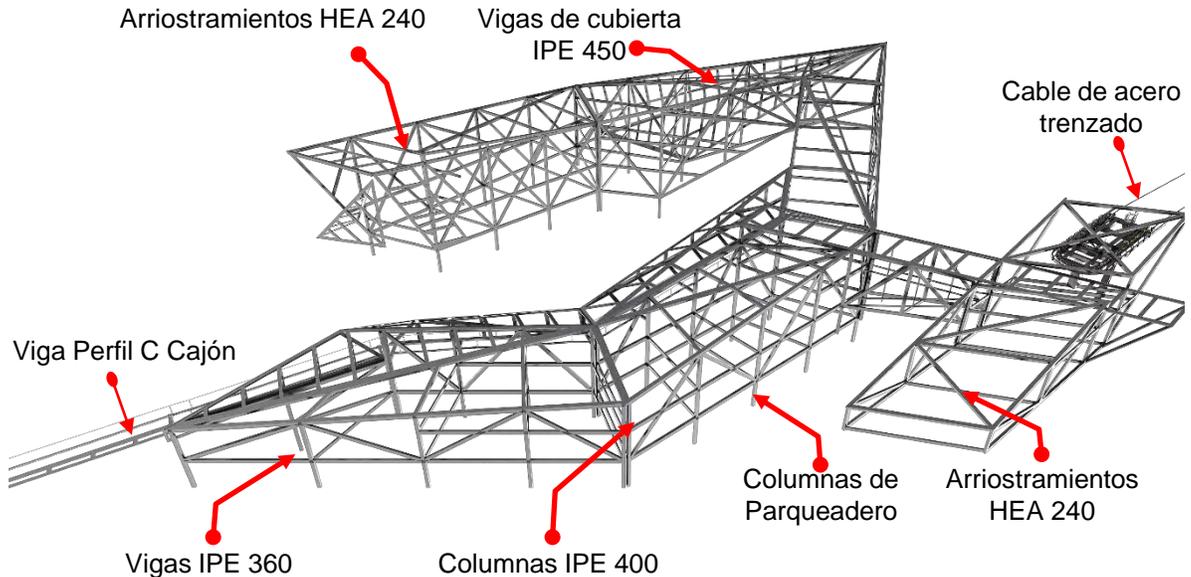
Esquema estructural. Fuente: Elaboración Propia
